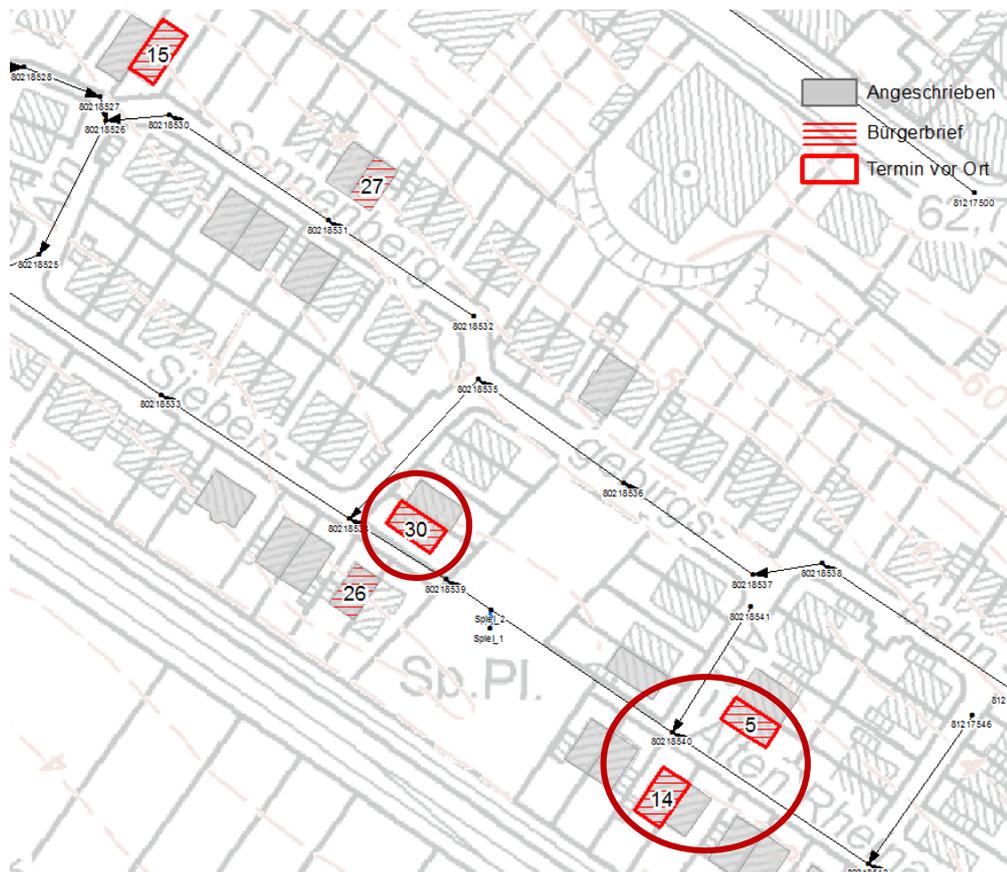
Lageplan - Markierung der Hauptbetroffenen
